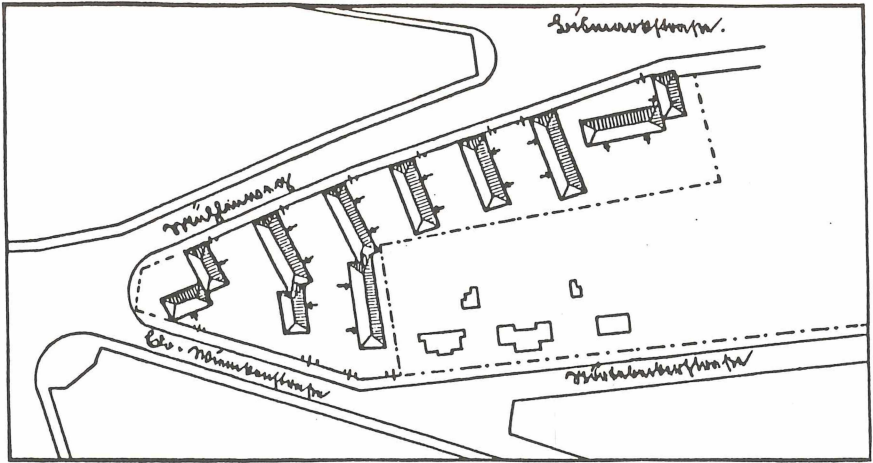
Lageplan des Zwickels Mühlenweg/Edo-Wiemken-Straße (BVR Gesch.ber., 1934)
